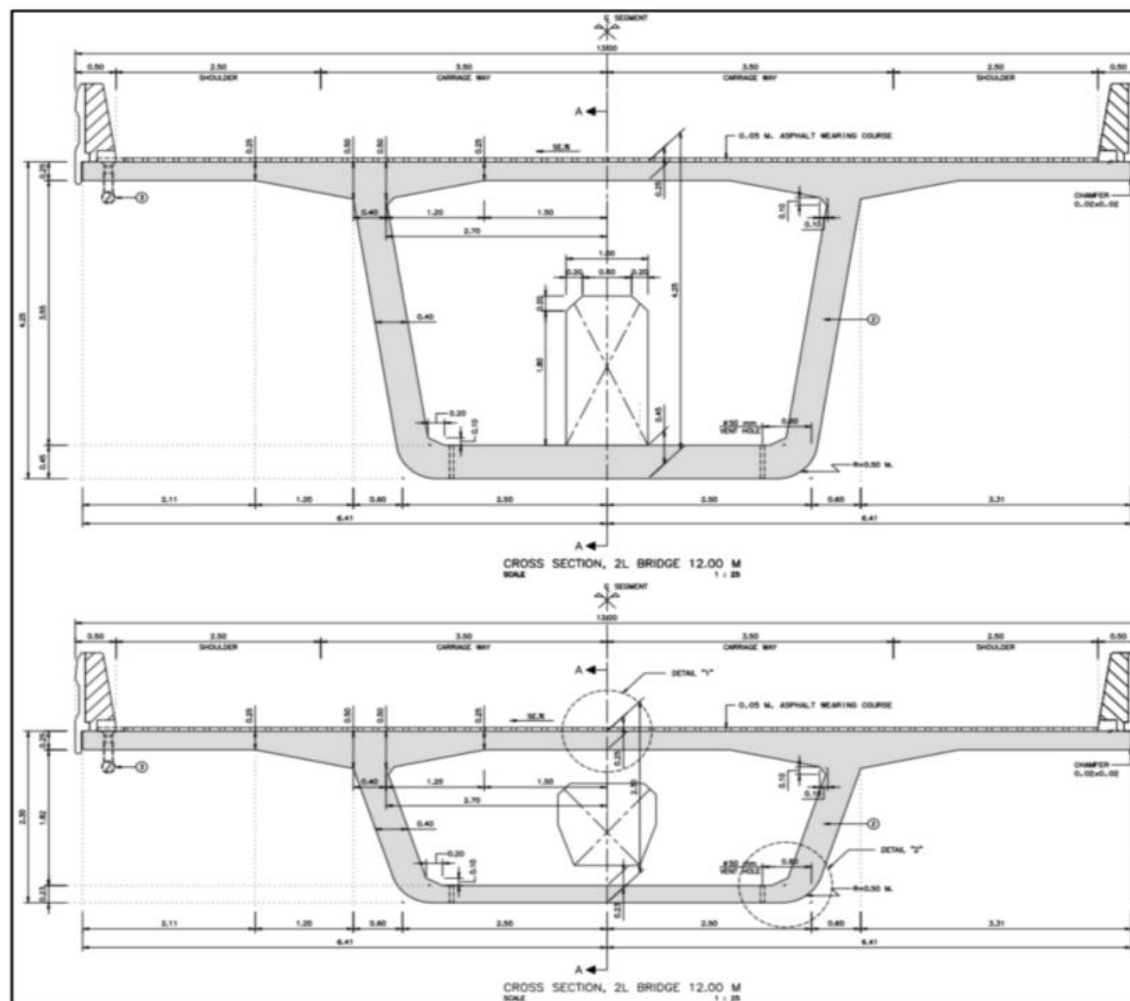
ตัวอย่าง Substructure สะพานคอนกรีตอัดแรงรูปกล่องใช้ชิ้นส่วนหล่อสำเร็จ (Pre-cast Segmental Concrete Box Girder) รูปแบบความกว้าง Box 9.0 เมตร
